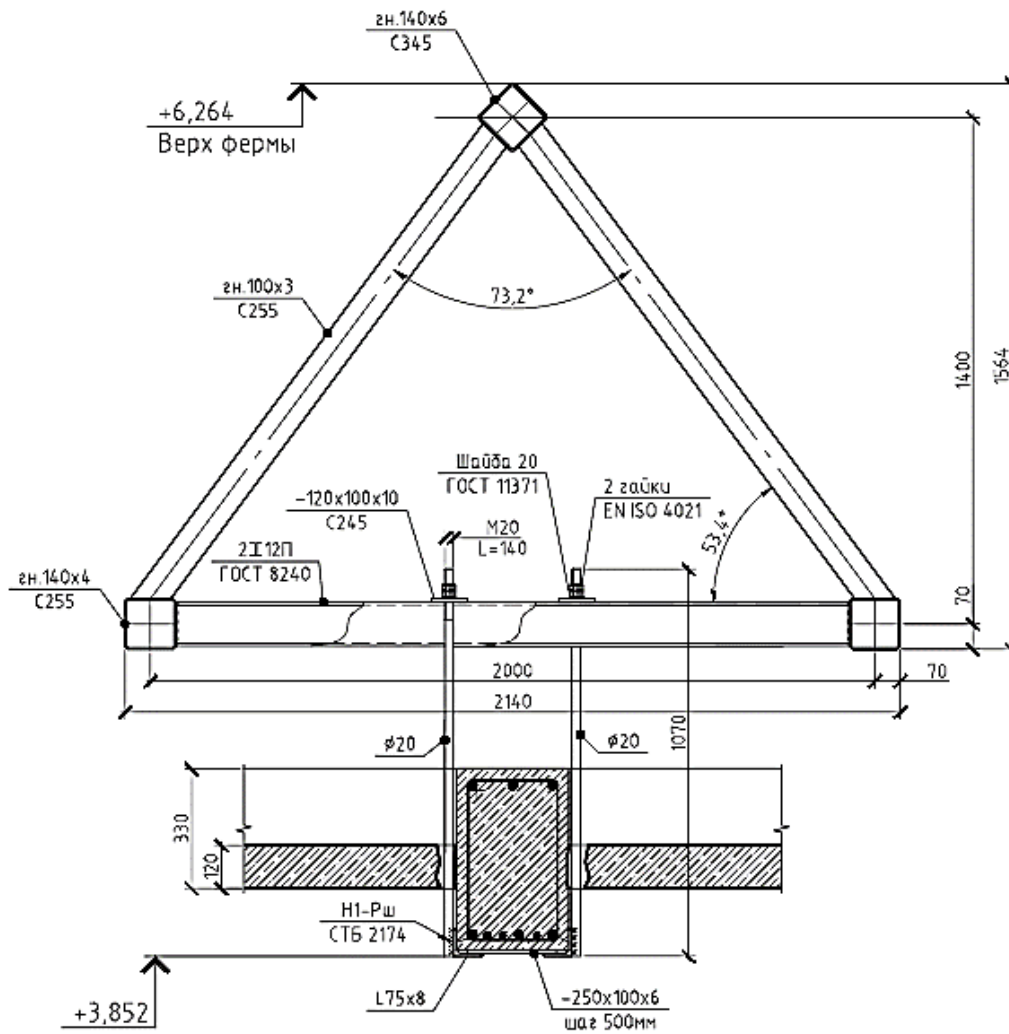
Конструктивное решение конструкции усиления чердачного перекрытия
